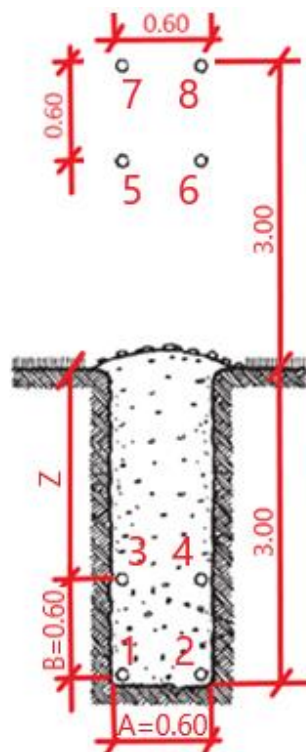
Geometría de la sección transversal de la trinchera con tubos imagen.
